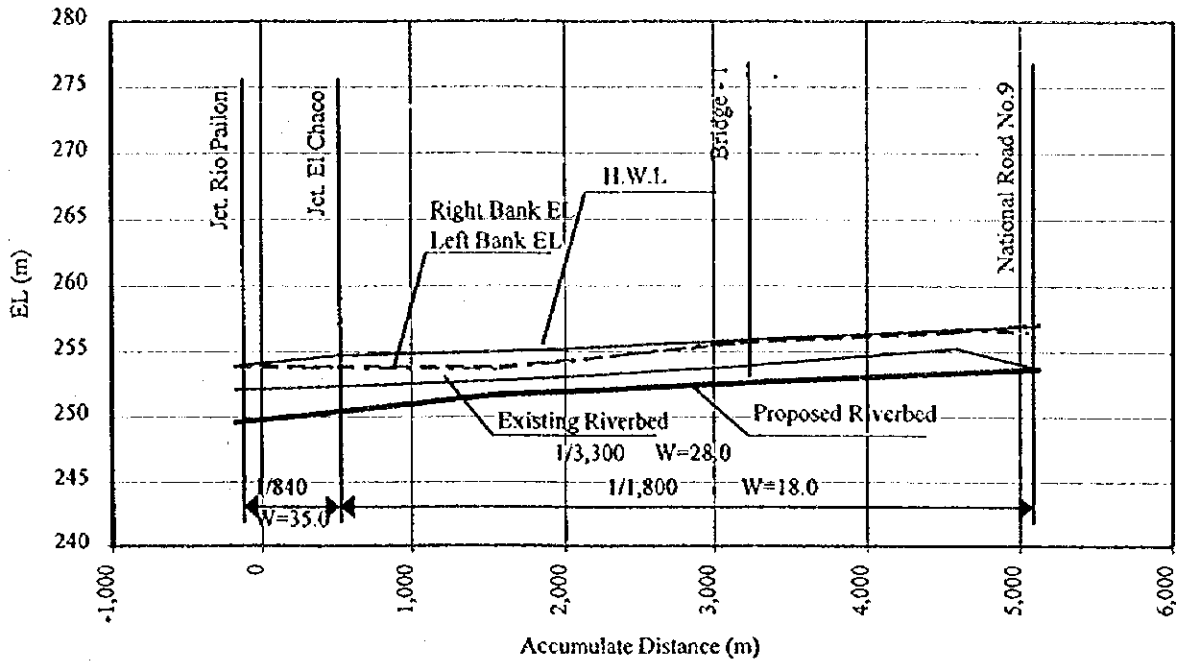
(1) PERFIL LONGITUDINAL DEL MEJORAMIENTO DE DRENAJE
